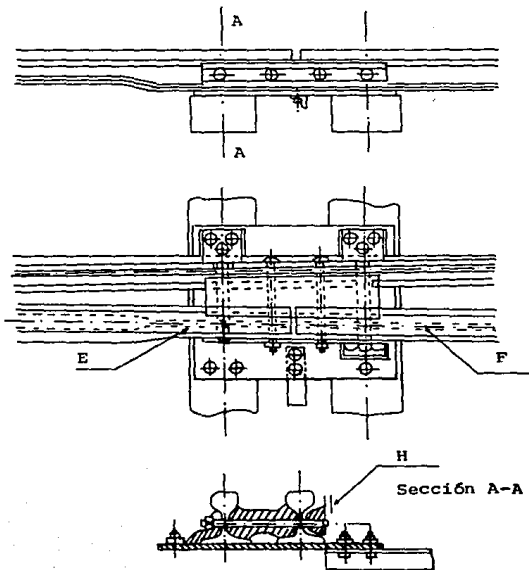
c Dispositivo de anclaje tipo cojinete-placa.
